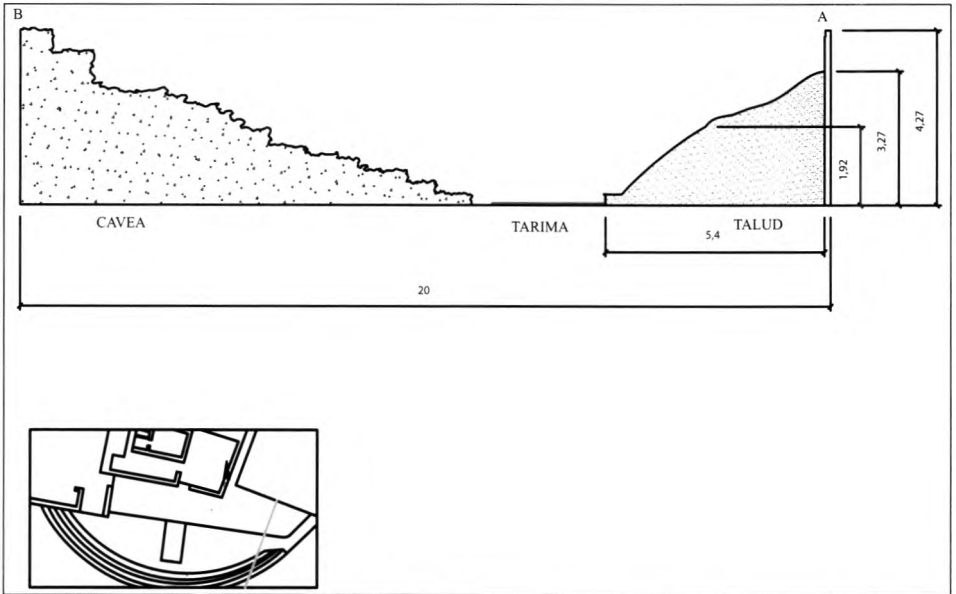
Sección Norte-Sur del área a excavar al aire libre, con la berma y la zona inferior bajo el entarimado
